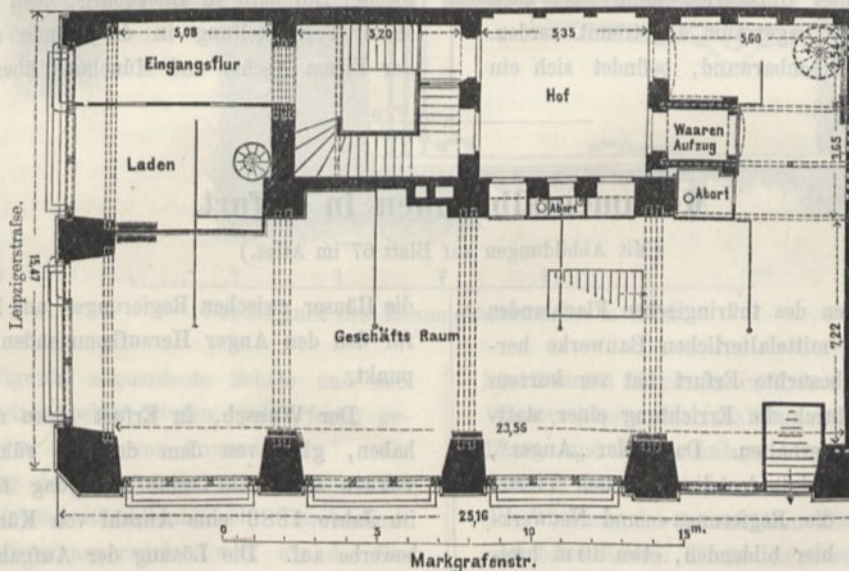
Grundriss vom Erdgeschofs.
